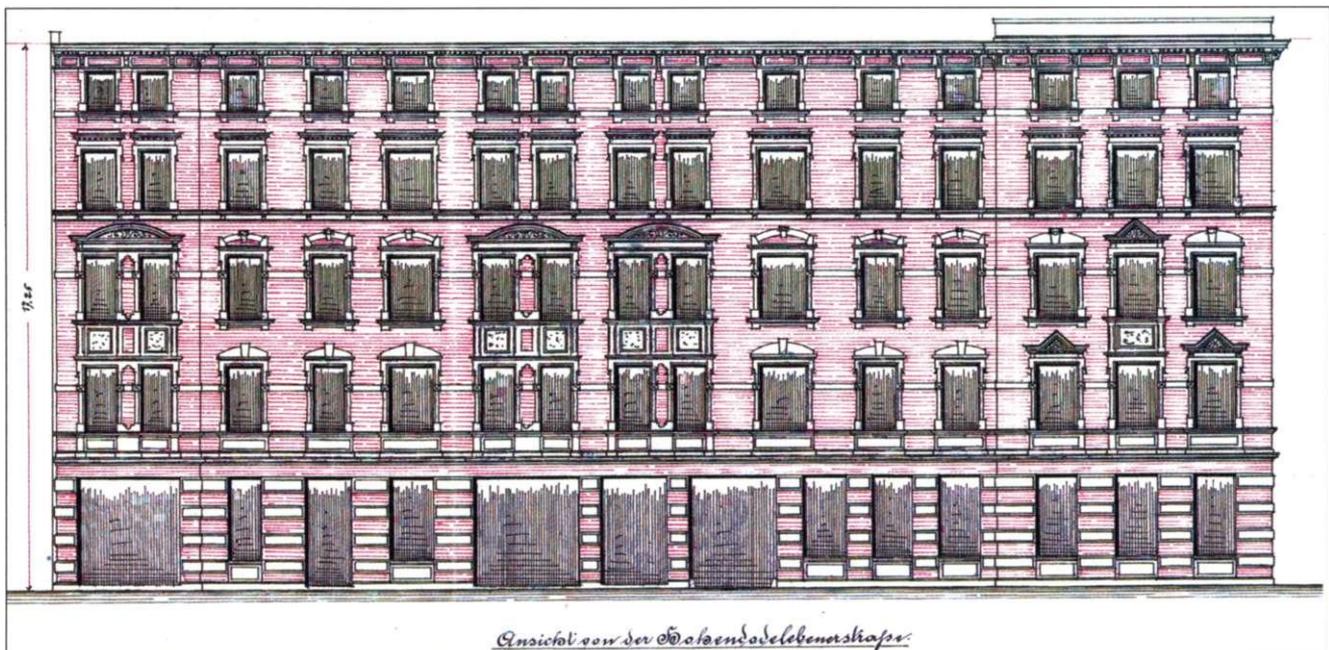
Liebknechtstraße 30, Arndtstraße 26, Fassadenaufriß an der Liebknechtstraße
